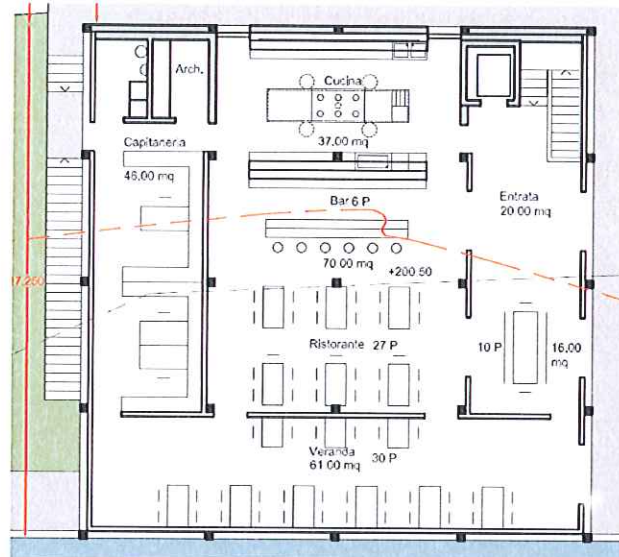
Edificio – Pianta piano ristorante, bar e capitaneria
